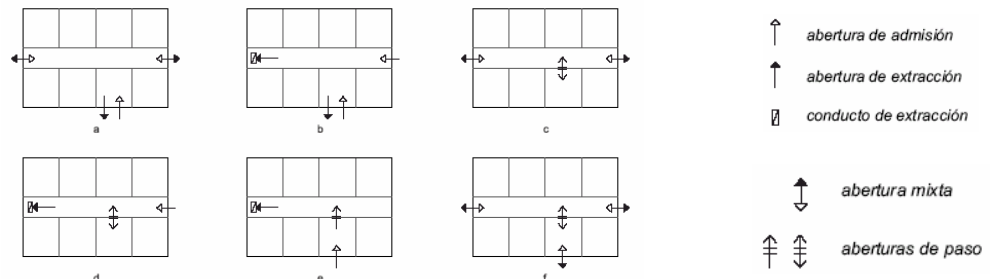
Ejemplos de ventilación en el interior de las viviendas
